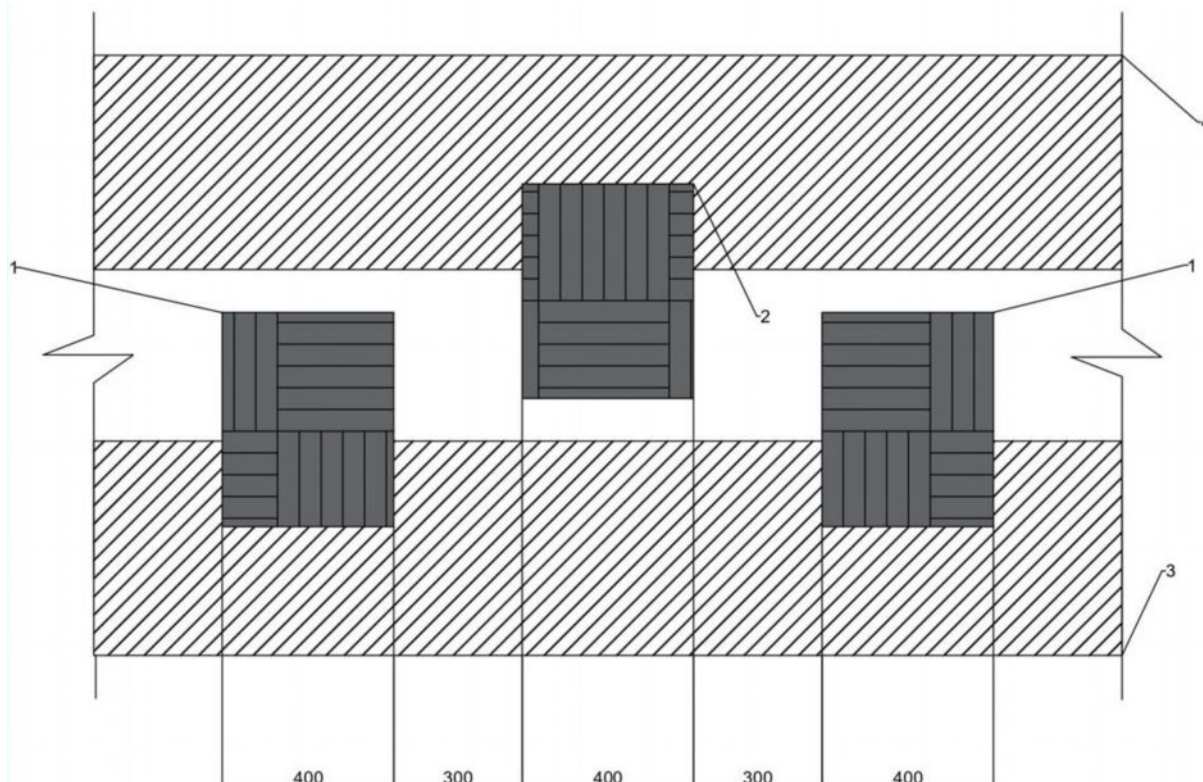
Фрагмент сечения фундамента со скользящим поясом
